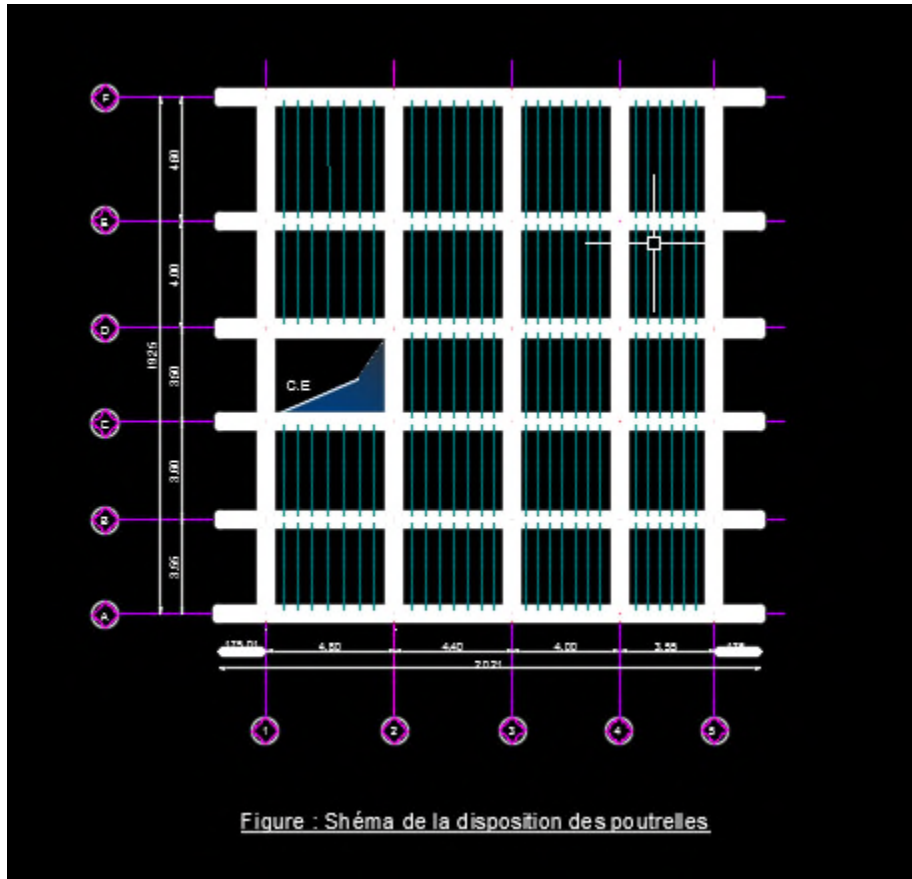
Plan de disposition des poutrelles (1<sup>er</sup> Étage)
